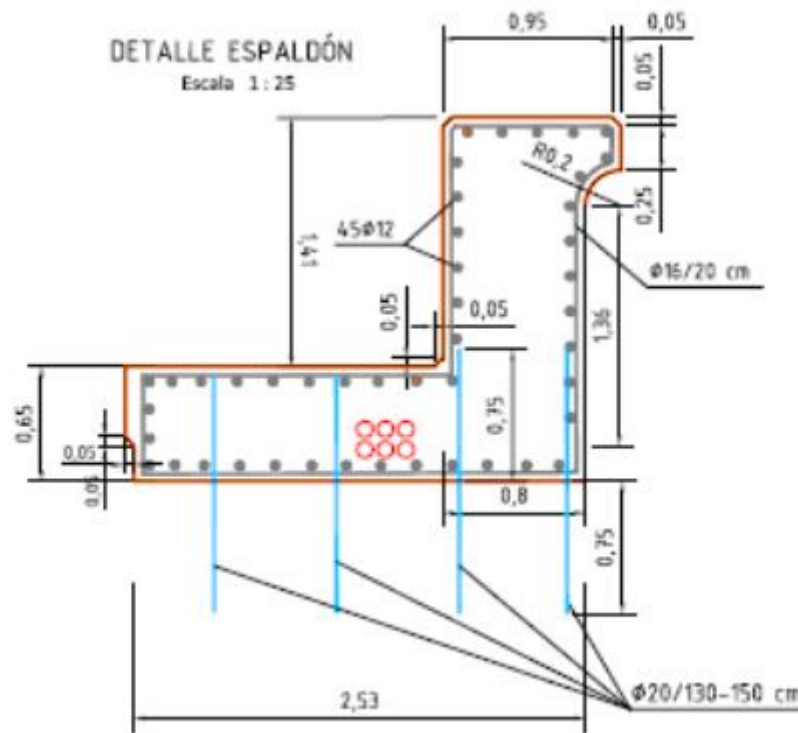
Sección de armados de la solución de acero. (Puerto de Alicante)
